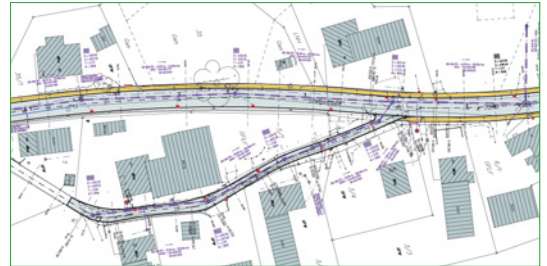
Lageplanausschnitt Ortsdurchfahrt Eichen, Stadt Ochsenhausen
